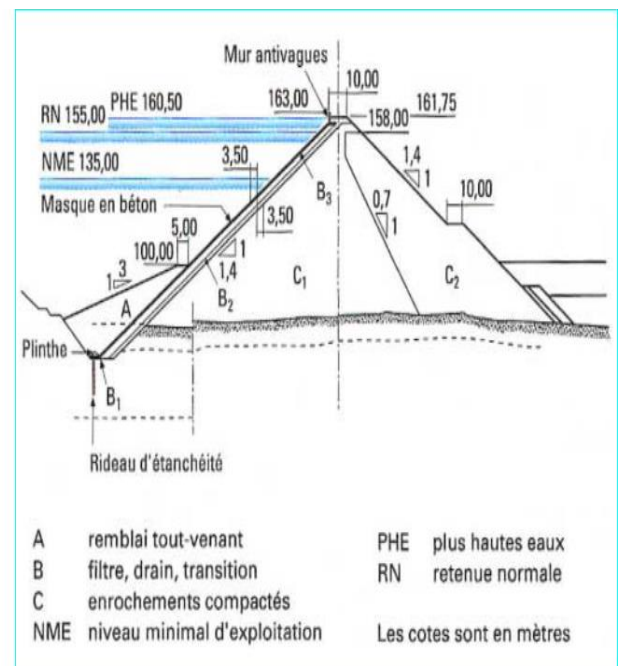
Barrage à masque en béton de Khao Laem (Thaïlande)
